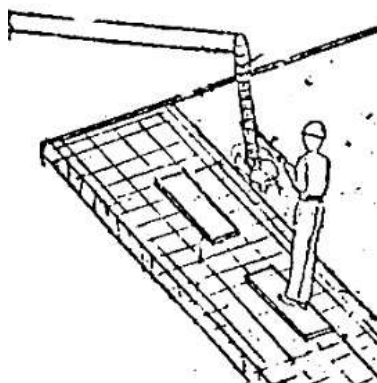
Бетонирование плиты перекрытия
